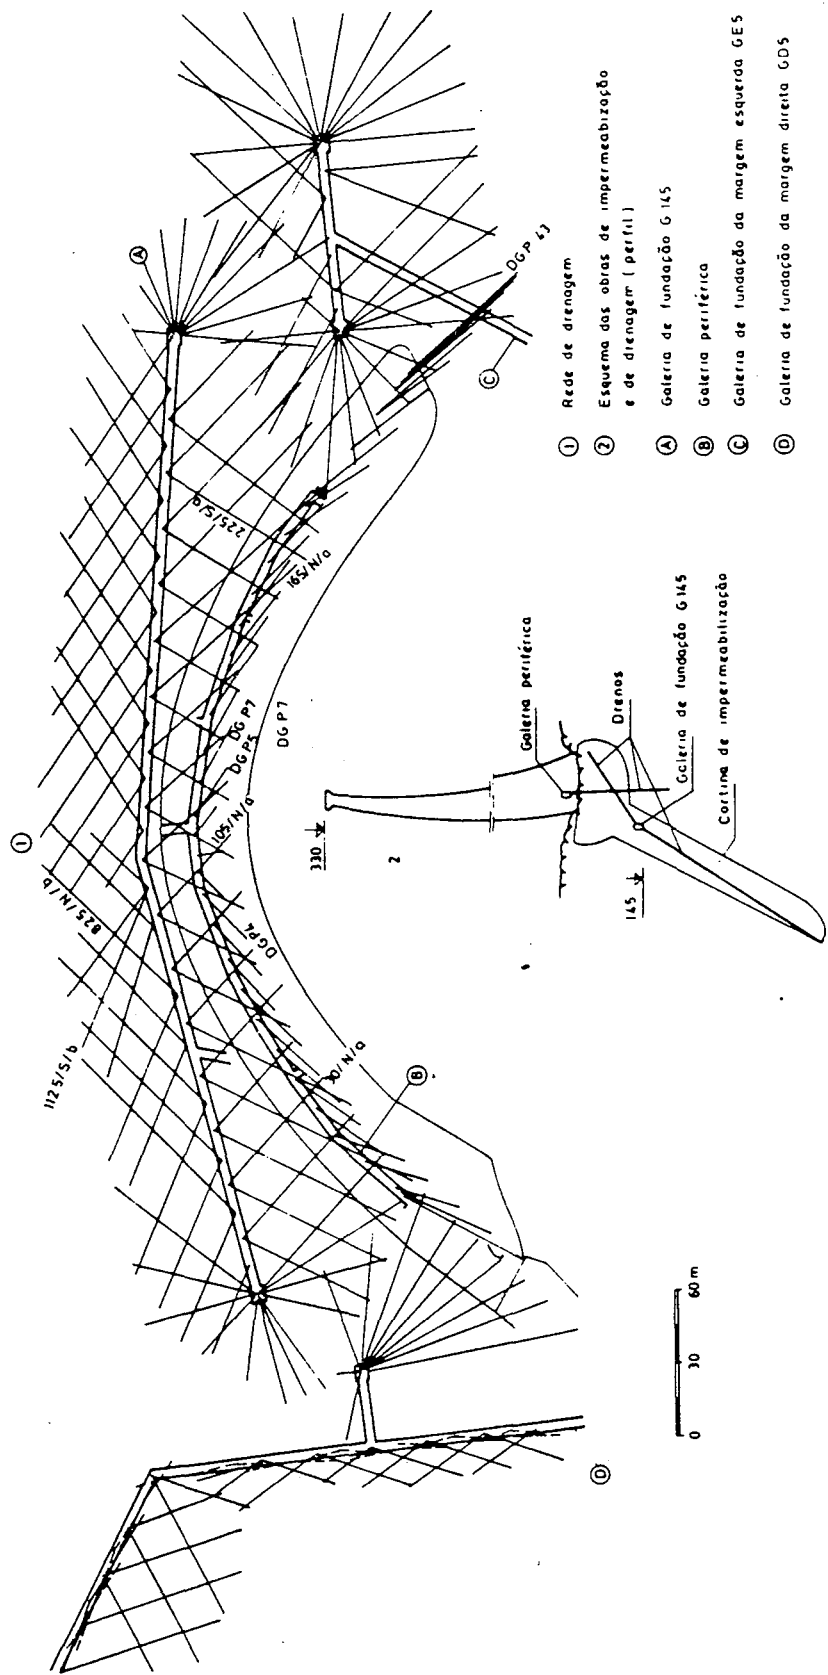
Localização da rede de drenagem e definição em alçado da zona de tratamento da fundação.
